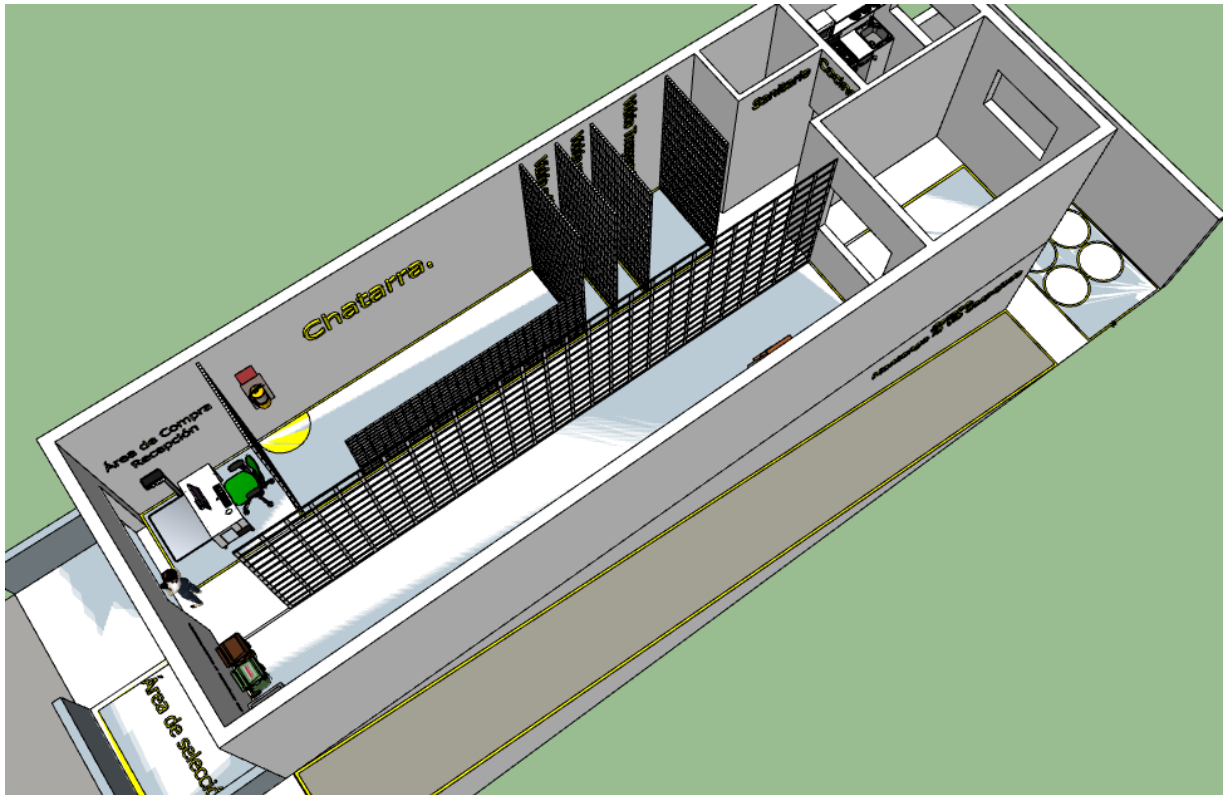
Plano de distribución propuesto Primer nivel
